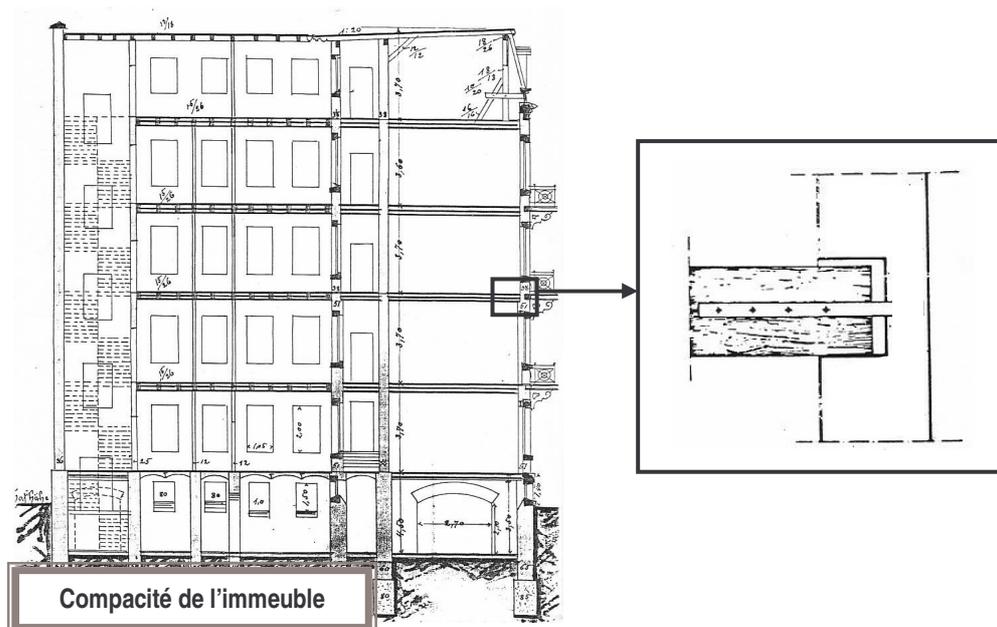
Coupe générale et de détail sur la liaison plancher – façade du bâtiment 2
